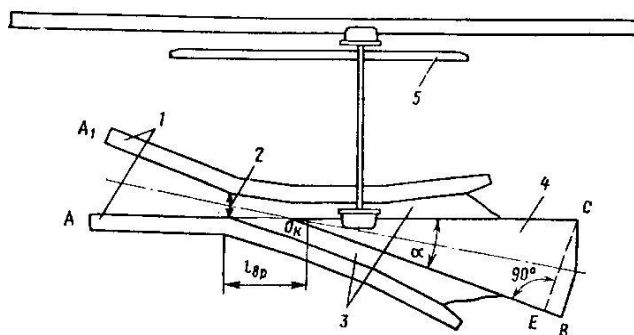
Загальний вигляд гострої хрестовини: 1 – вусовики; 2 – горло; 3 – жолоби; 4 – осердя; 5 – контррейки
